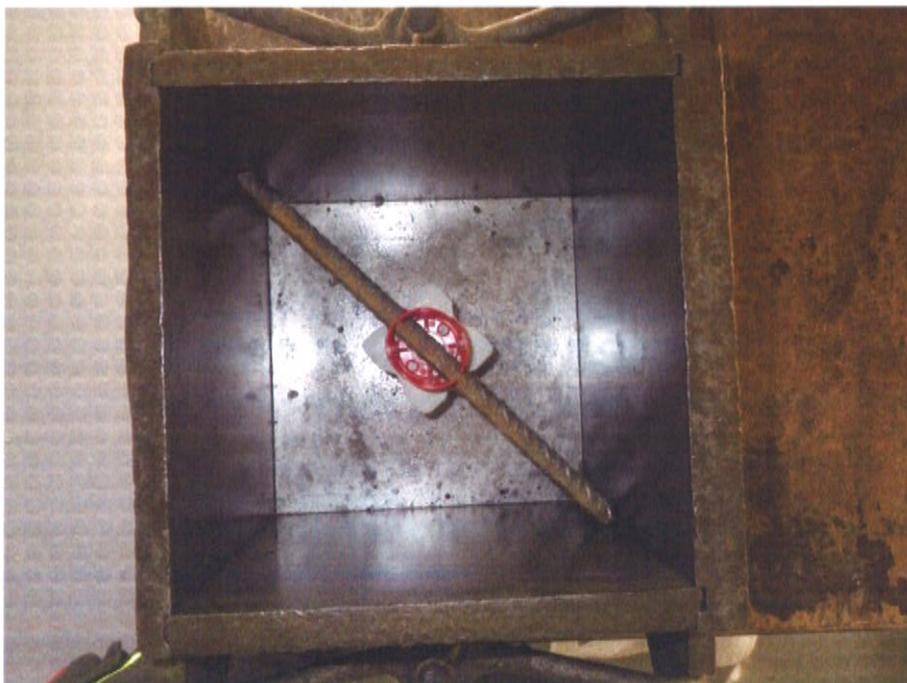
Würfelschalung mit eingebautem Abstandshalter
